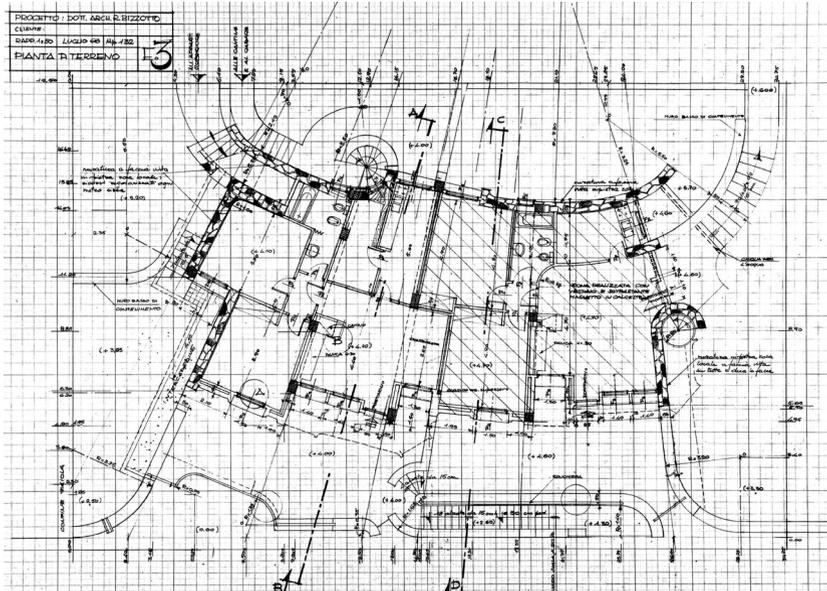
Planimetria della villa Di Raimo a Sperlonga, 1968. (fonte: Archivio di Renata Bizzotto).
